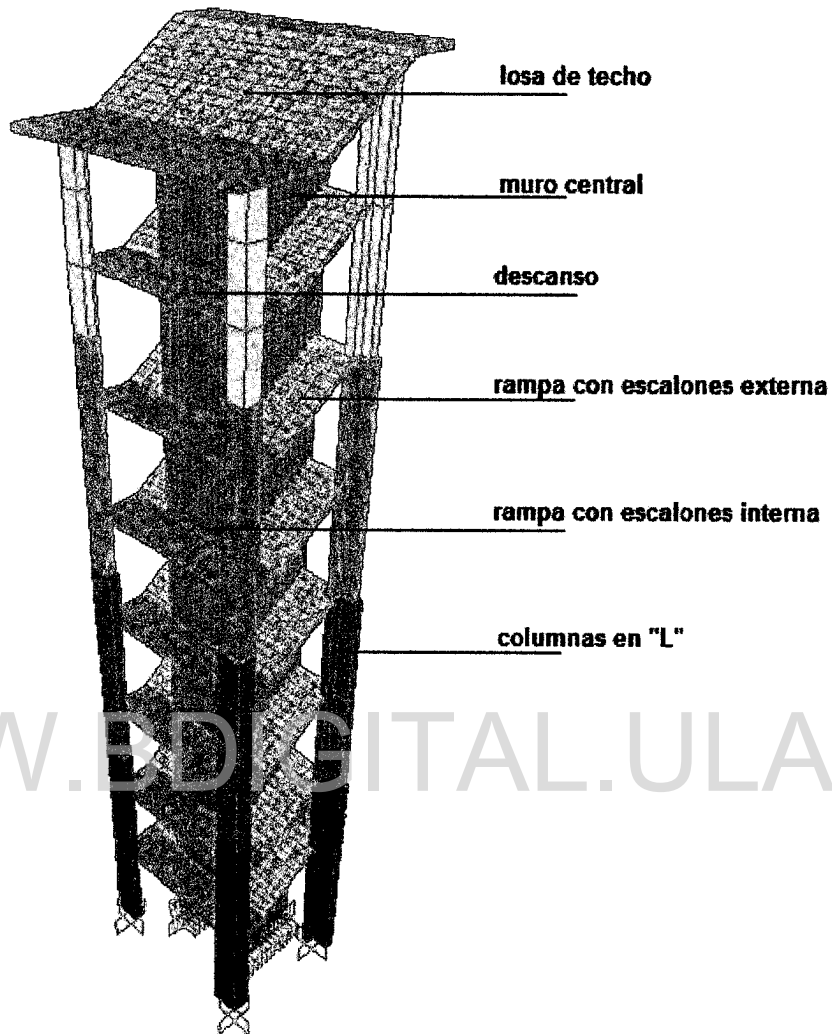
, Detalle modelado de escalera concreto armado, columnas "frames" y áreas "shell".
